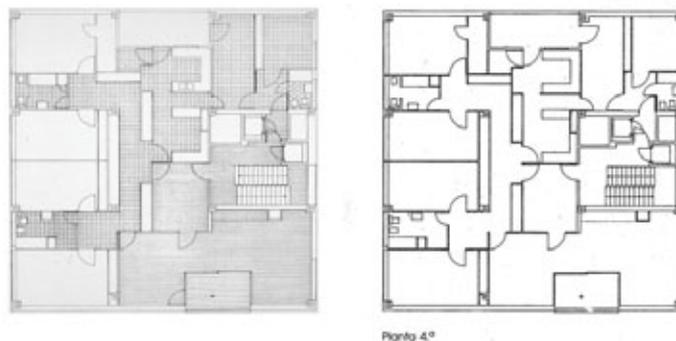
Plano de pavimentos del estado antes de rehabilitación del 85 y plano de actuación de planta cuarta. Josep Llinás.
